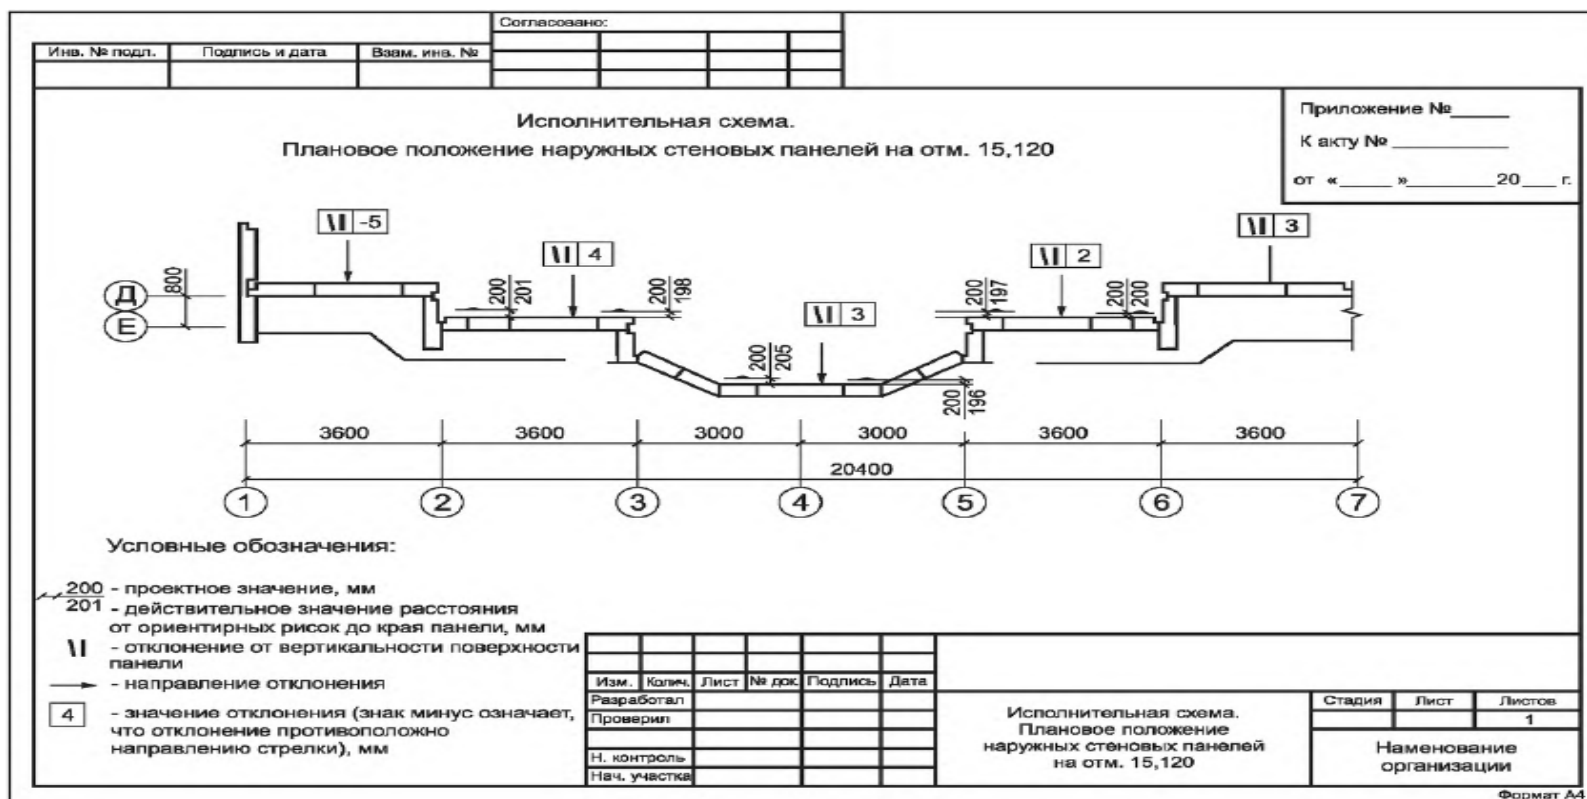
Исполнительная геодезическая схема. Наружные стеновые панели этажа жилого дома (плановое положение)
